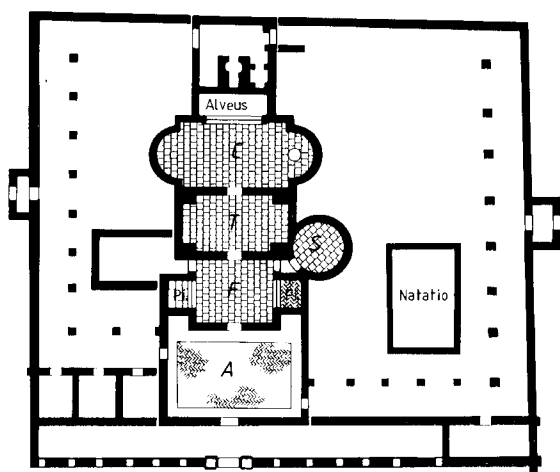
Thermen von Coriovallum/Heerlen, Grundriß Grundriß und Rekonstruktion des 1. Bauzustandes
